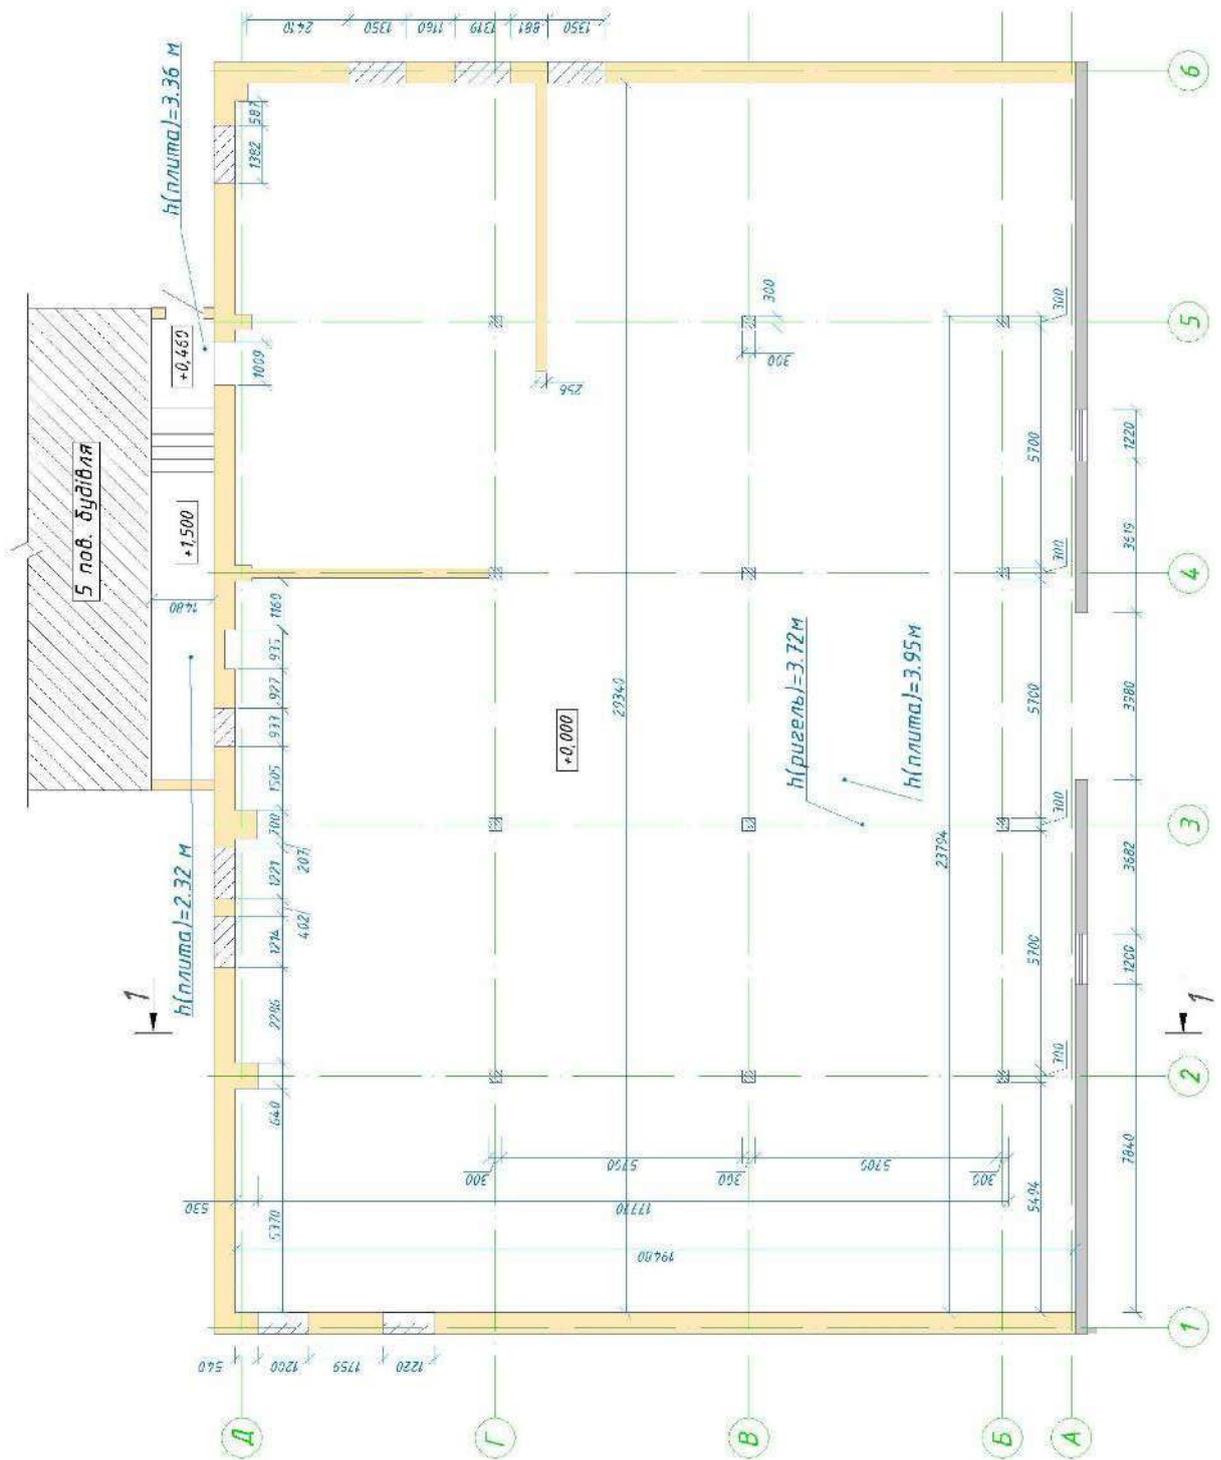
Схематичний план 1-ого поверху будівлі обстеження
